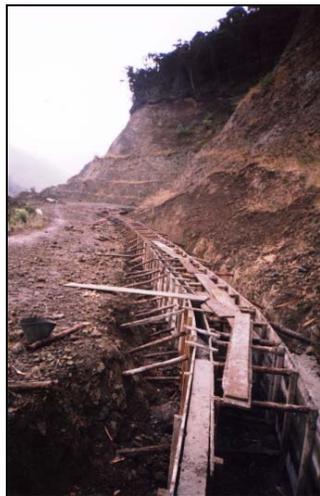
Limpieza del Canal para Medir y Encofrar
